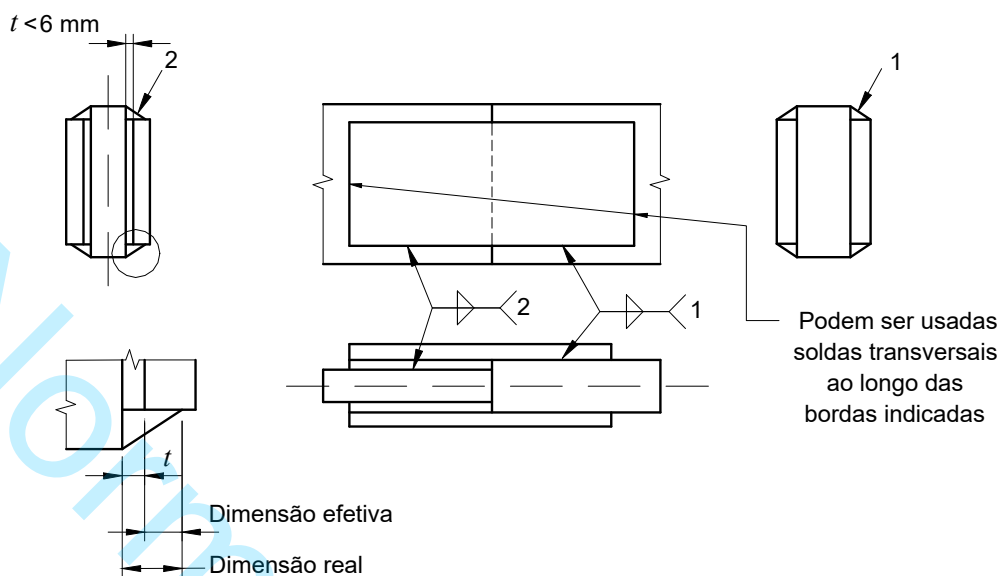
Chapa de enchimento com espessura inferior a 6 mm
